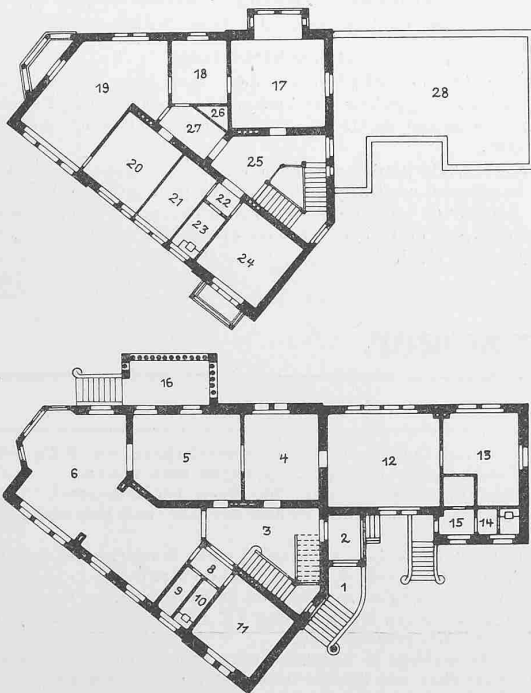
Grundrisse vom Erdgeschoss und vom I. Stock.
